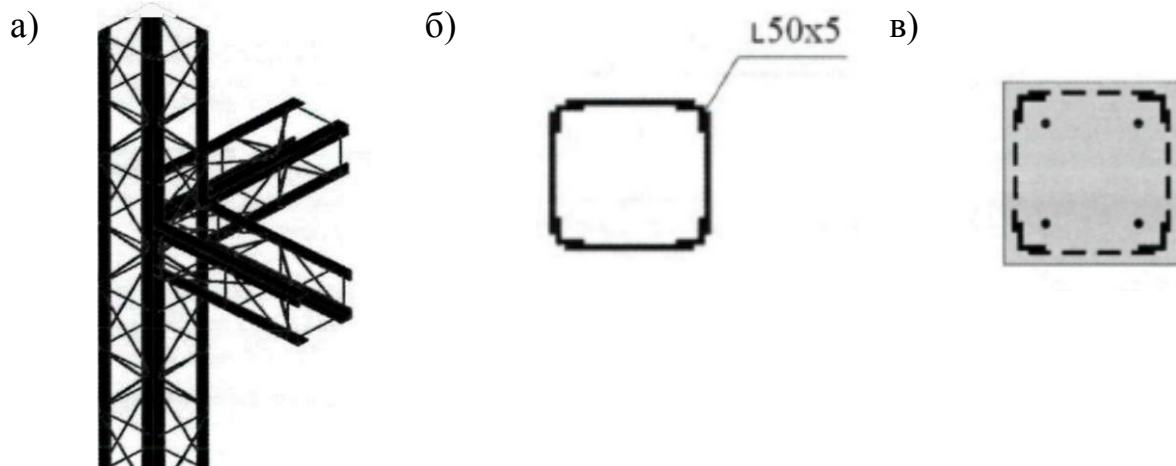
Елементи сталежелезобетонного каркаса: а - формуючий каркас; б - переріз колони каркаса; в - перетин колони після бетонування
